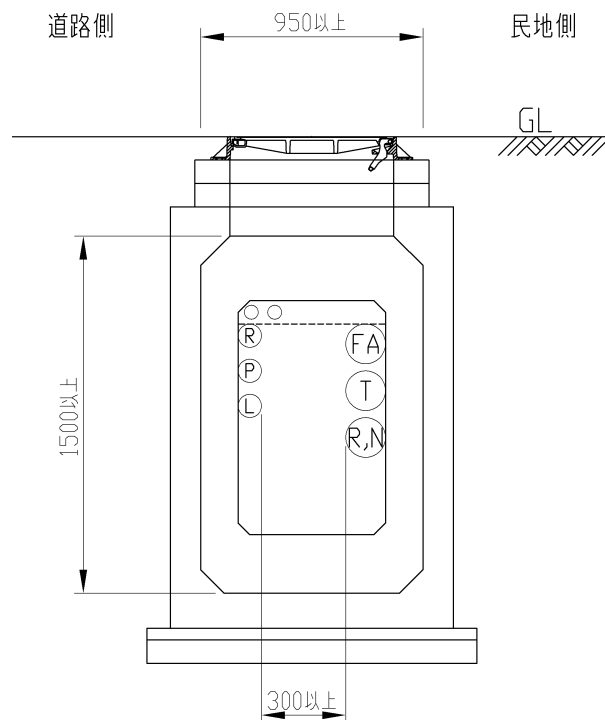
特殊部配置断面図 (RT 栴 (小))
